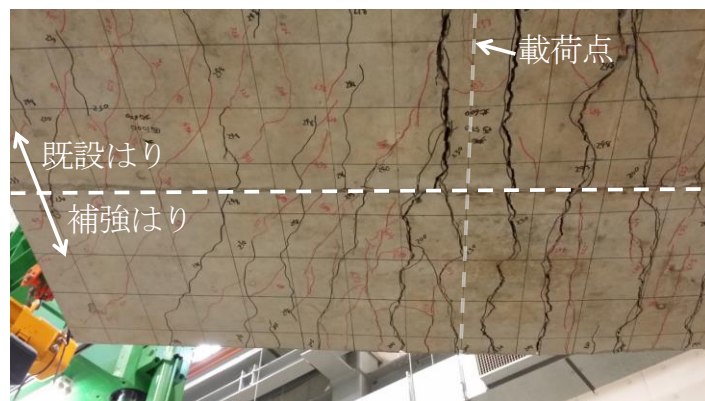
はり下面ひび割れ性状 (No.15, 実験終了後)
